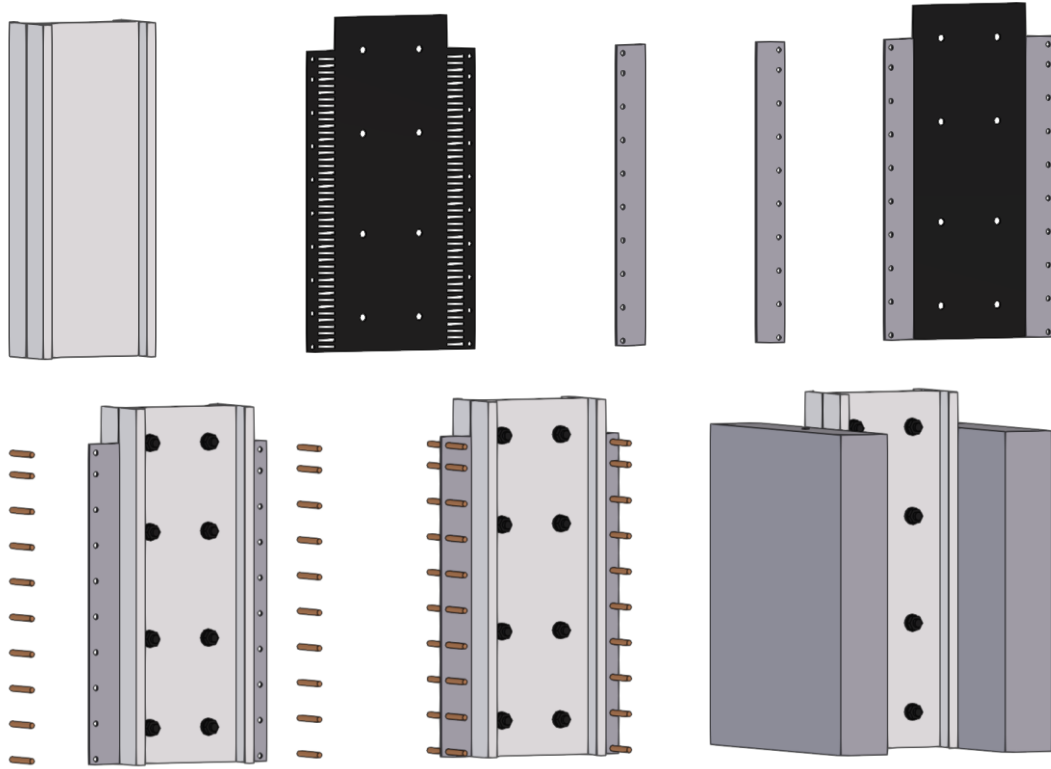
PO-PL-ISO deney elemanlarında kiriş ve plaka bağlantı detayı
